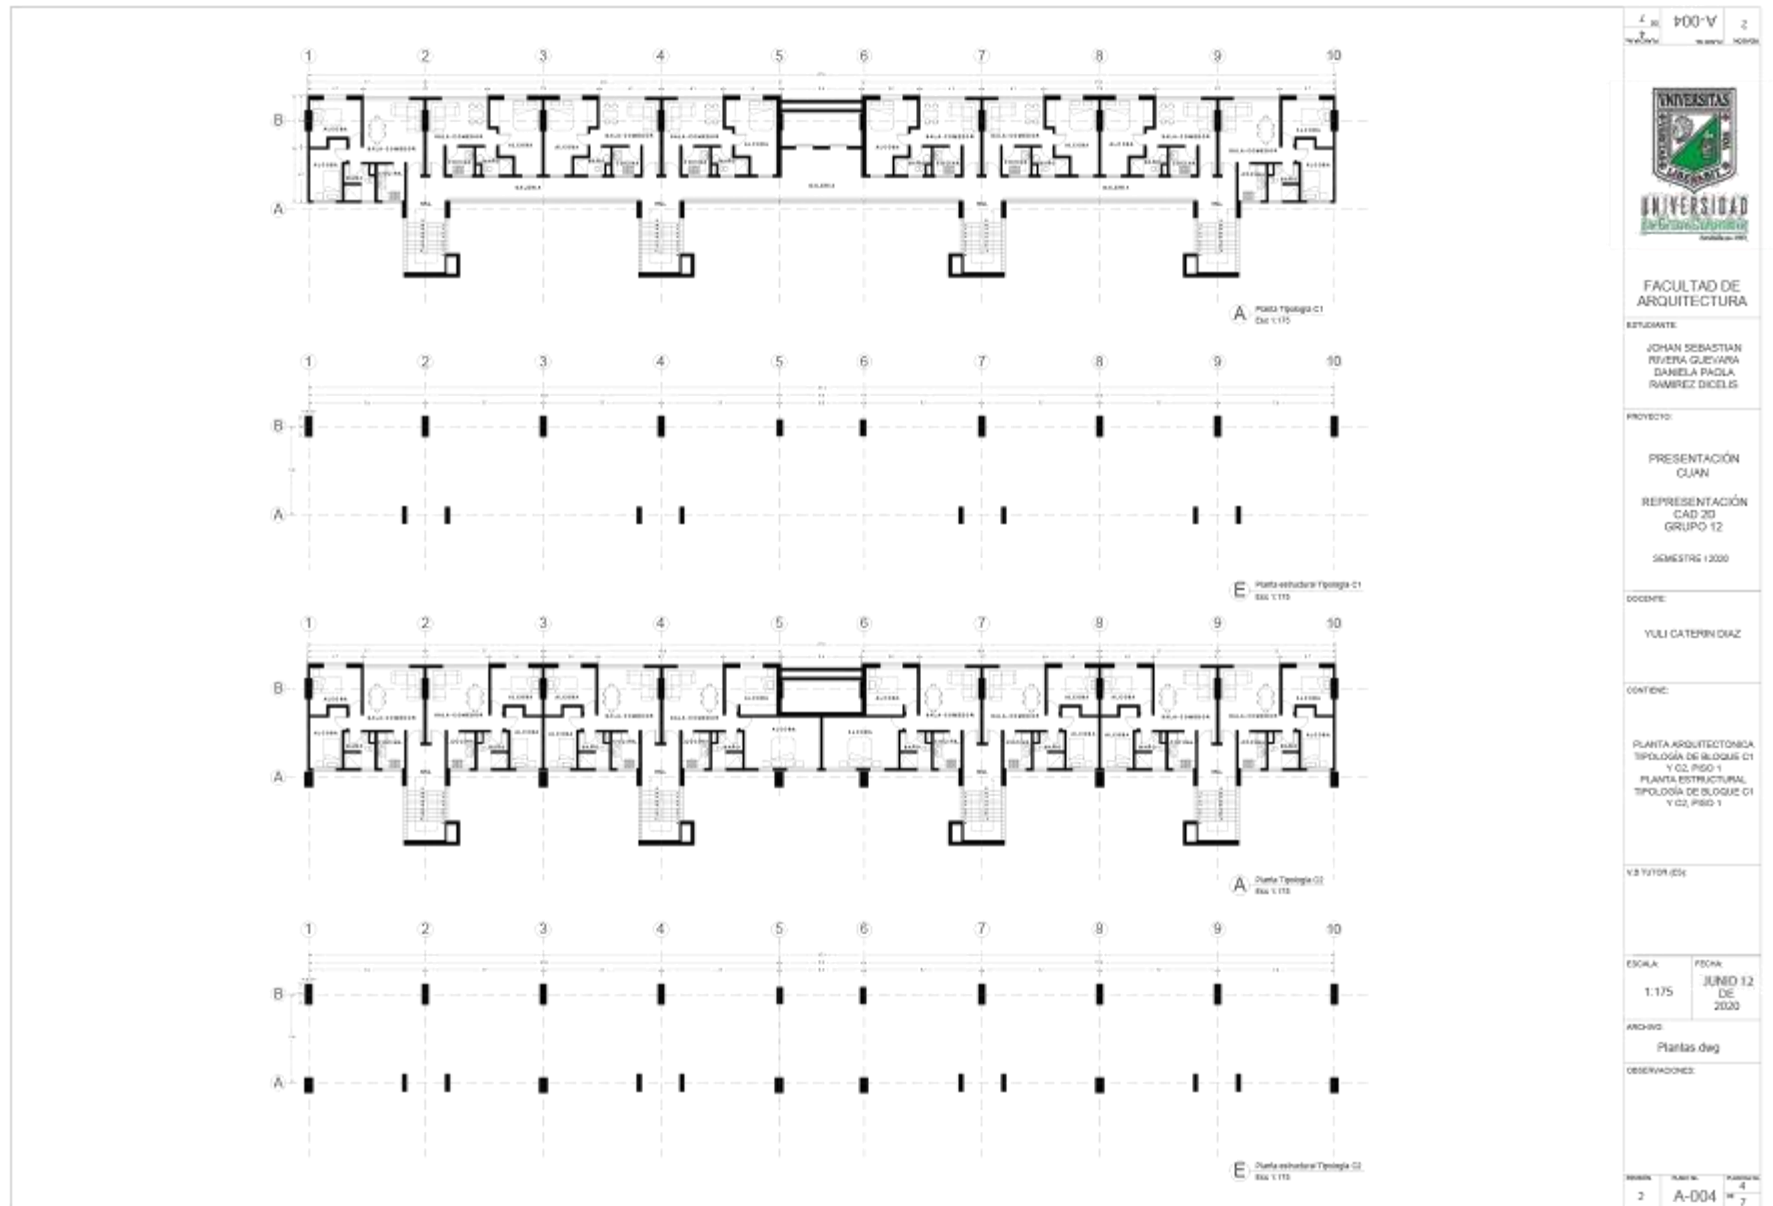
, Planta arquitectónica y estructural bloque Tipología C. Elaboración propia
